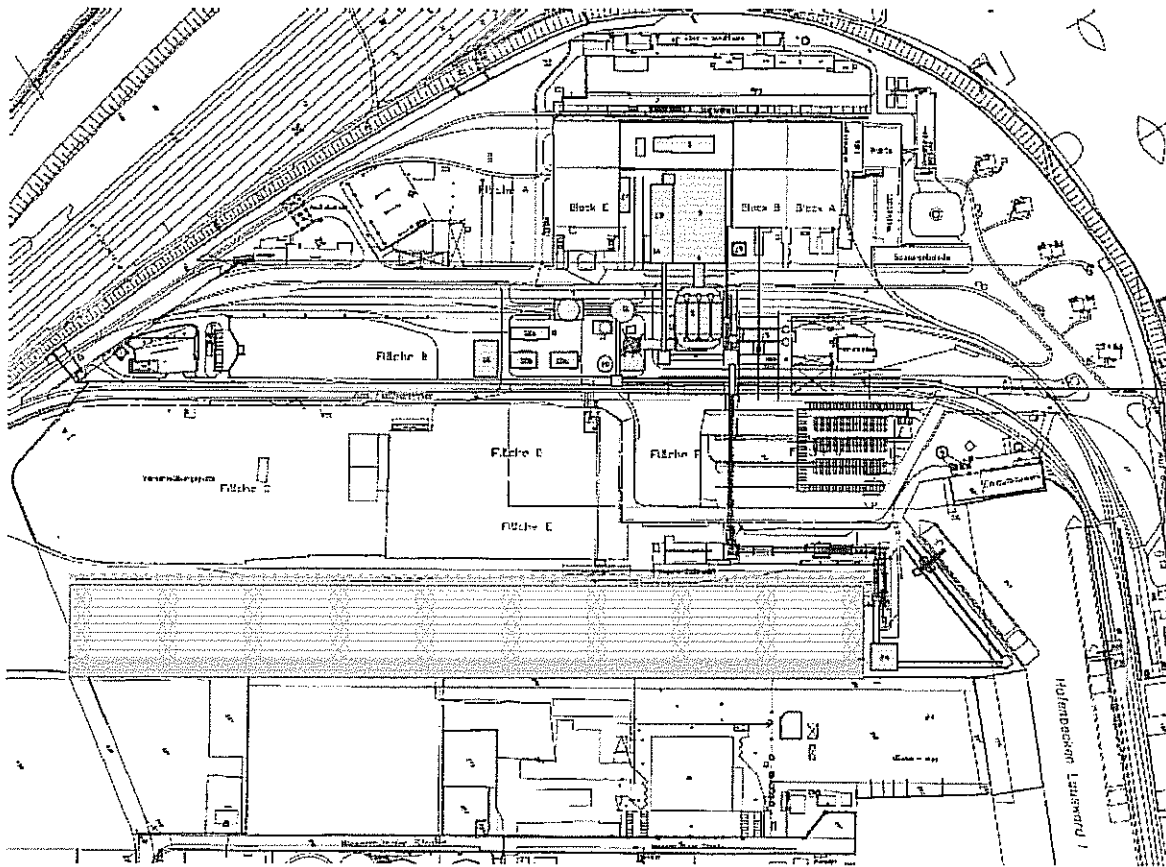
Darstellung der untersuchten Einhausung im Lageplan
